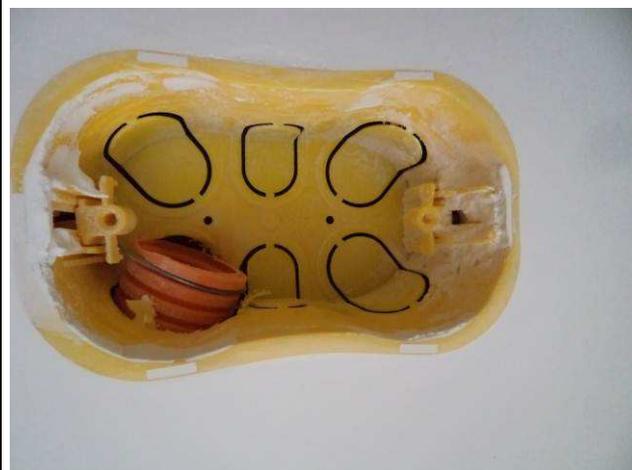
E: Infraestrutura instalações elétricas - caixas 2x4" drywall e eletrodutos corrugados.
